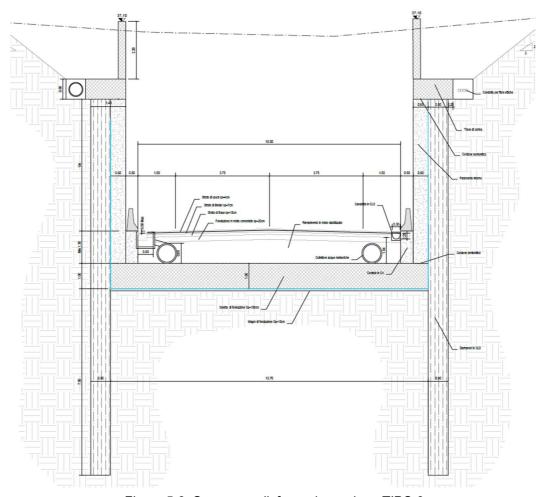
Scavo con diaframmi – sezione TIPO 3
